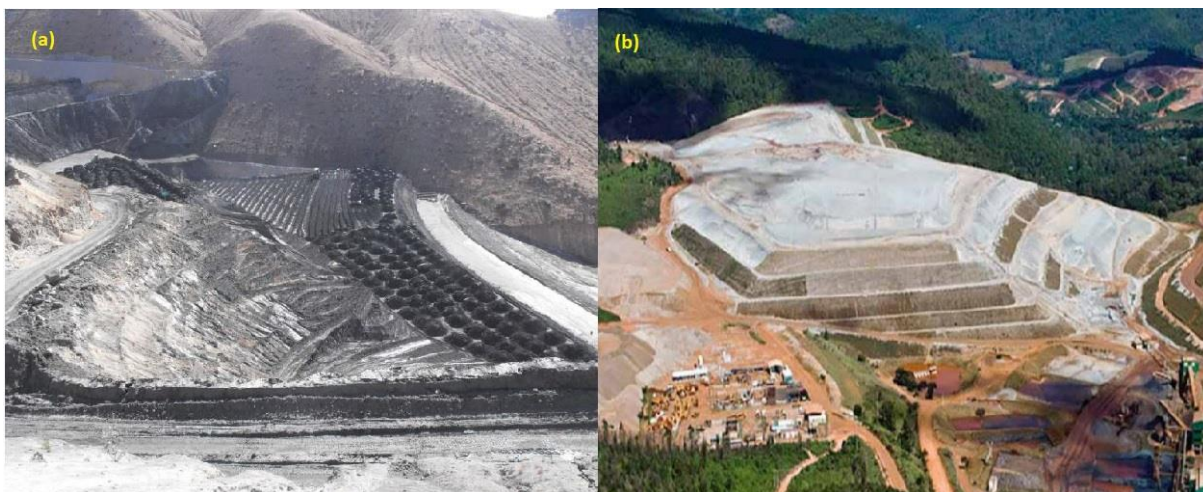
Pilhas de Rejeito Filtrado: (a) construção de pilhas, (b) pilhas já dispostas (adaptado de Golder Associates, 2015 e IBRAM 2016).
